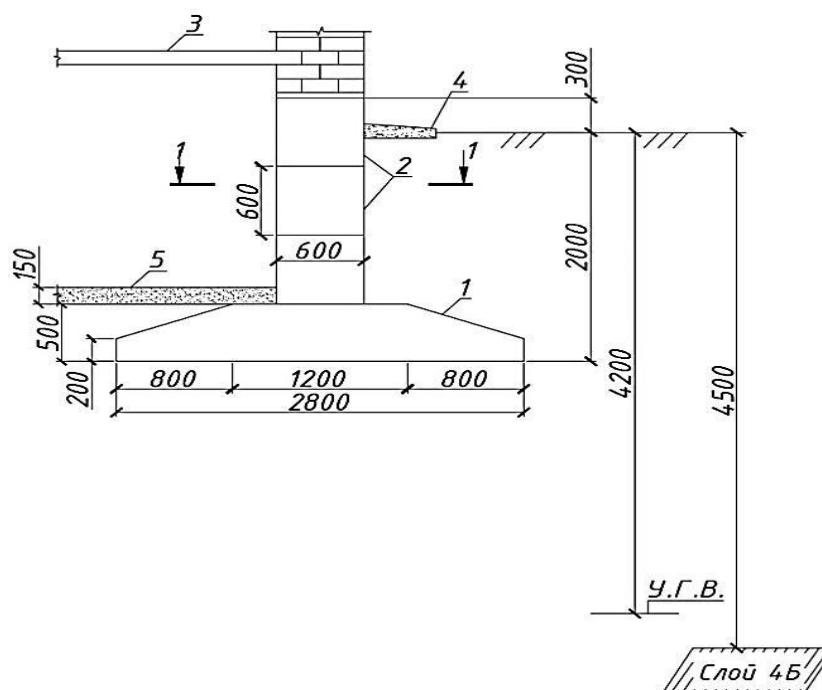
Конструкция фундамента: 1– фундаментная плита; 2 – фундаментные блоки; 3 – плита перекрытия; 4 – отмостка; 5 – земляной пол
